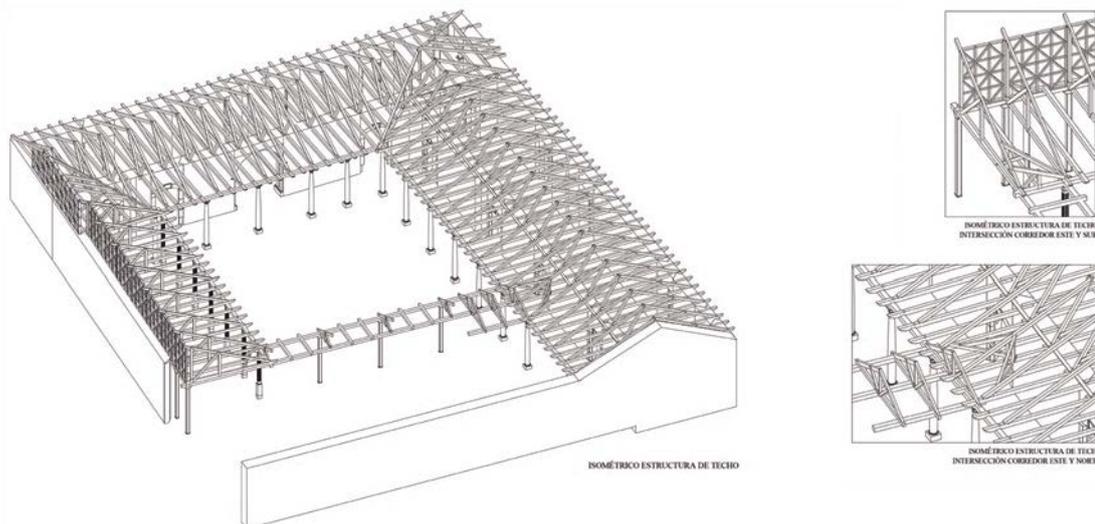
Esquema general de toda la estructura de madera que conforma el techo. Propuesta para la zona del comedor (zona sur). Encuentro entre las distintas partes de la estructura.
